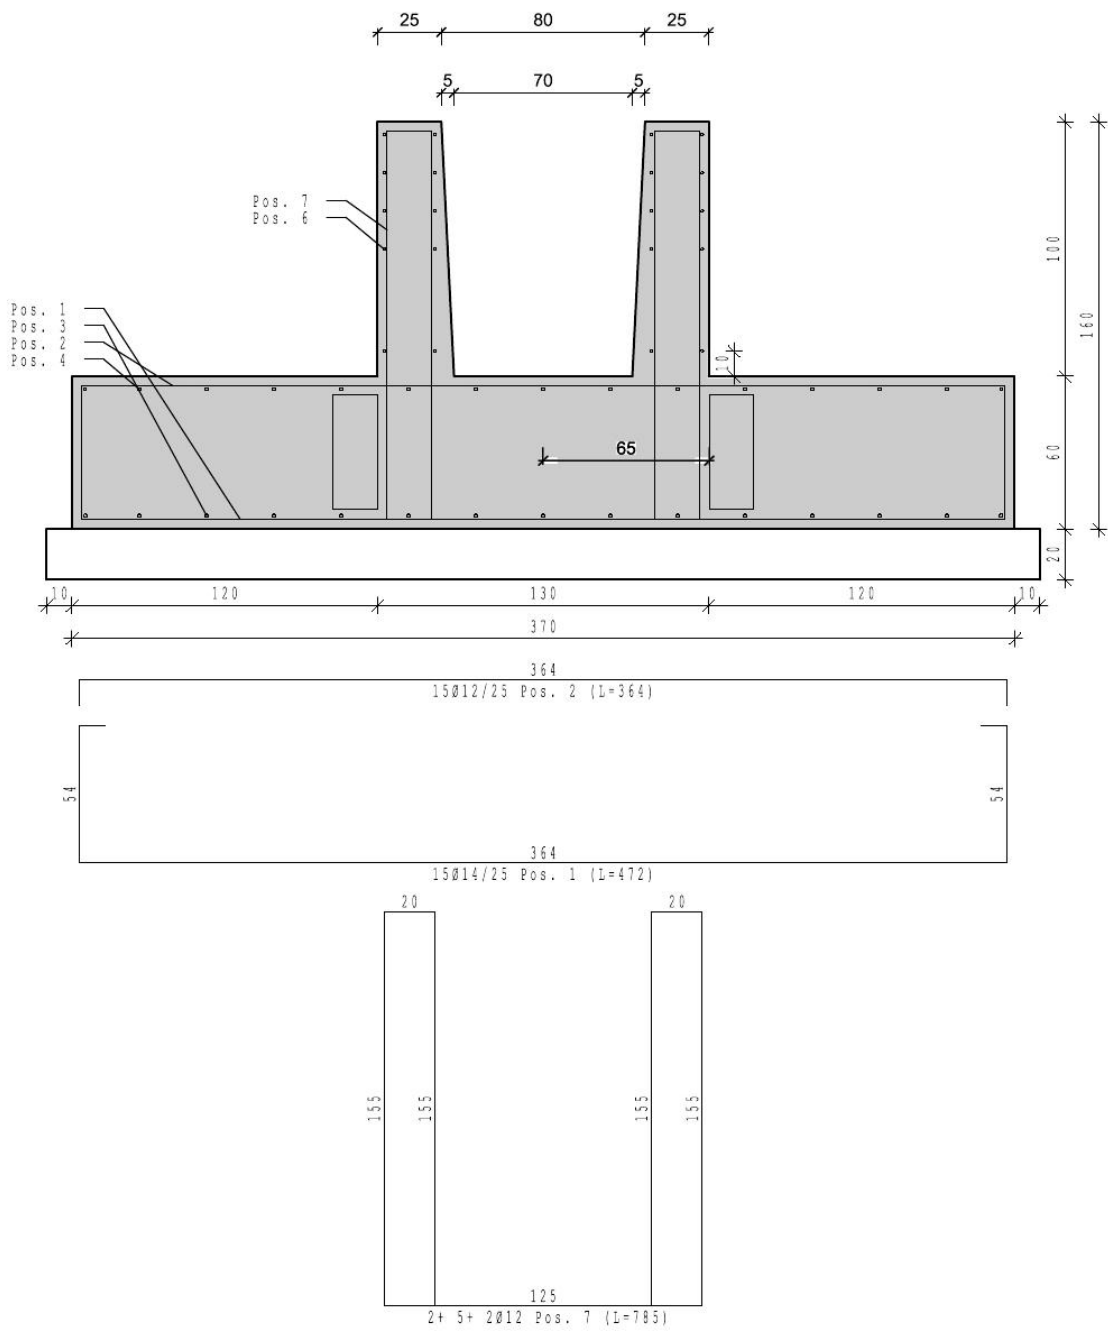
Particolare di A.2003.cap.us.T02 - Particolari plinti 2 e 4 - Sezione tipo plinto 2
